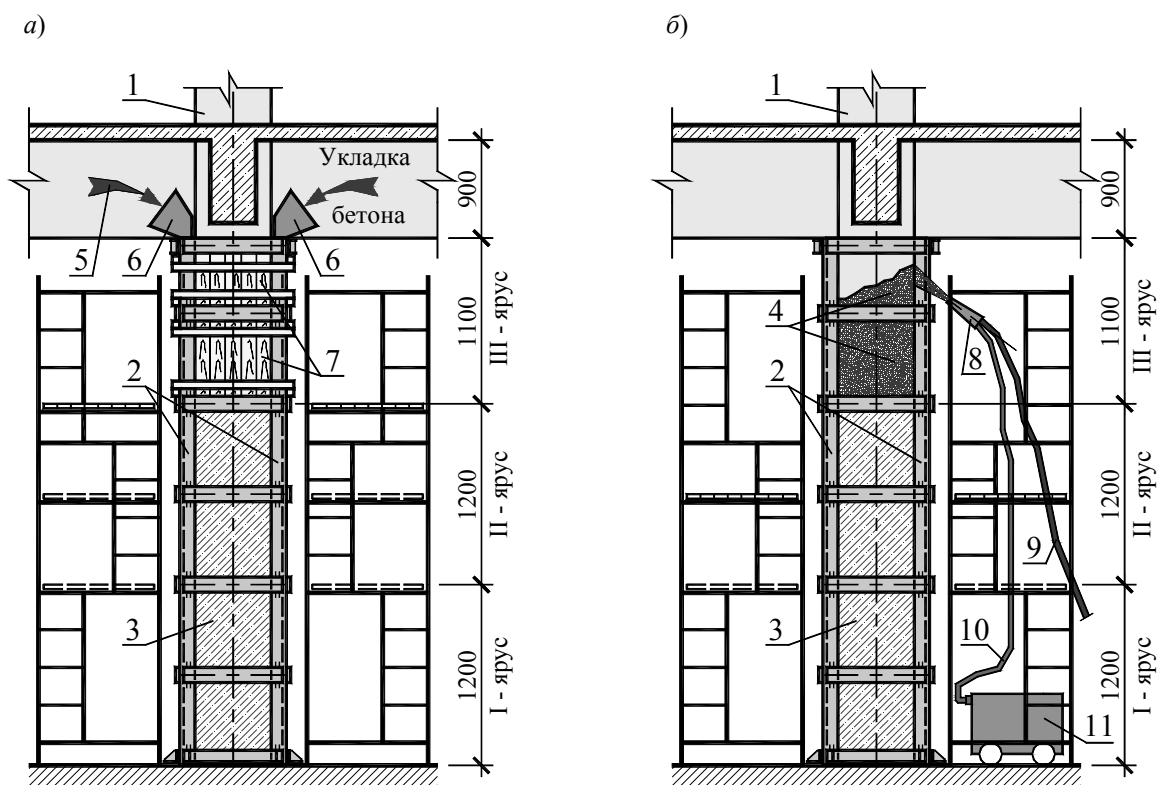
Применяемые способы подачи и укладки при усилении железобетонных колонн стальной обоймой с обетонированием: а – подача и укладка бетонной смеси через проемы в верхней части опалубки; б – бетонирование конструкции усиления торкретированием; 1 – усиливаемая колонна; 2 – стальная обойма усиления; 3 – бетонная обойма; 4 – торкрет-бетон; 5 – бетонная смесь; 6 – распределительная воронка; 7 – опалубка; 8 – сопло; 9 – материальный шланг; 10 – шланг для воды; 11 – компрессор
